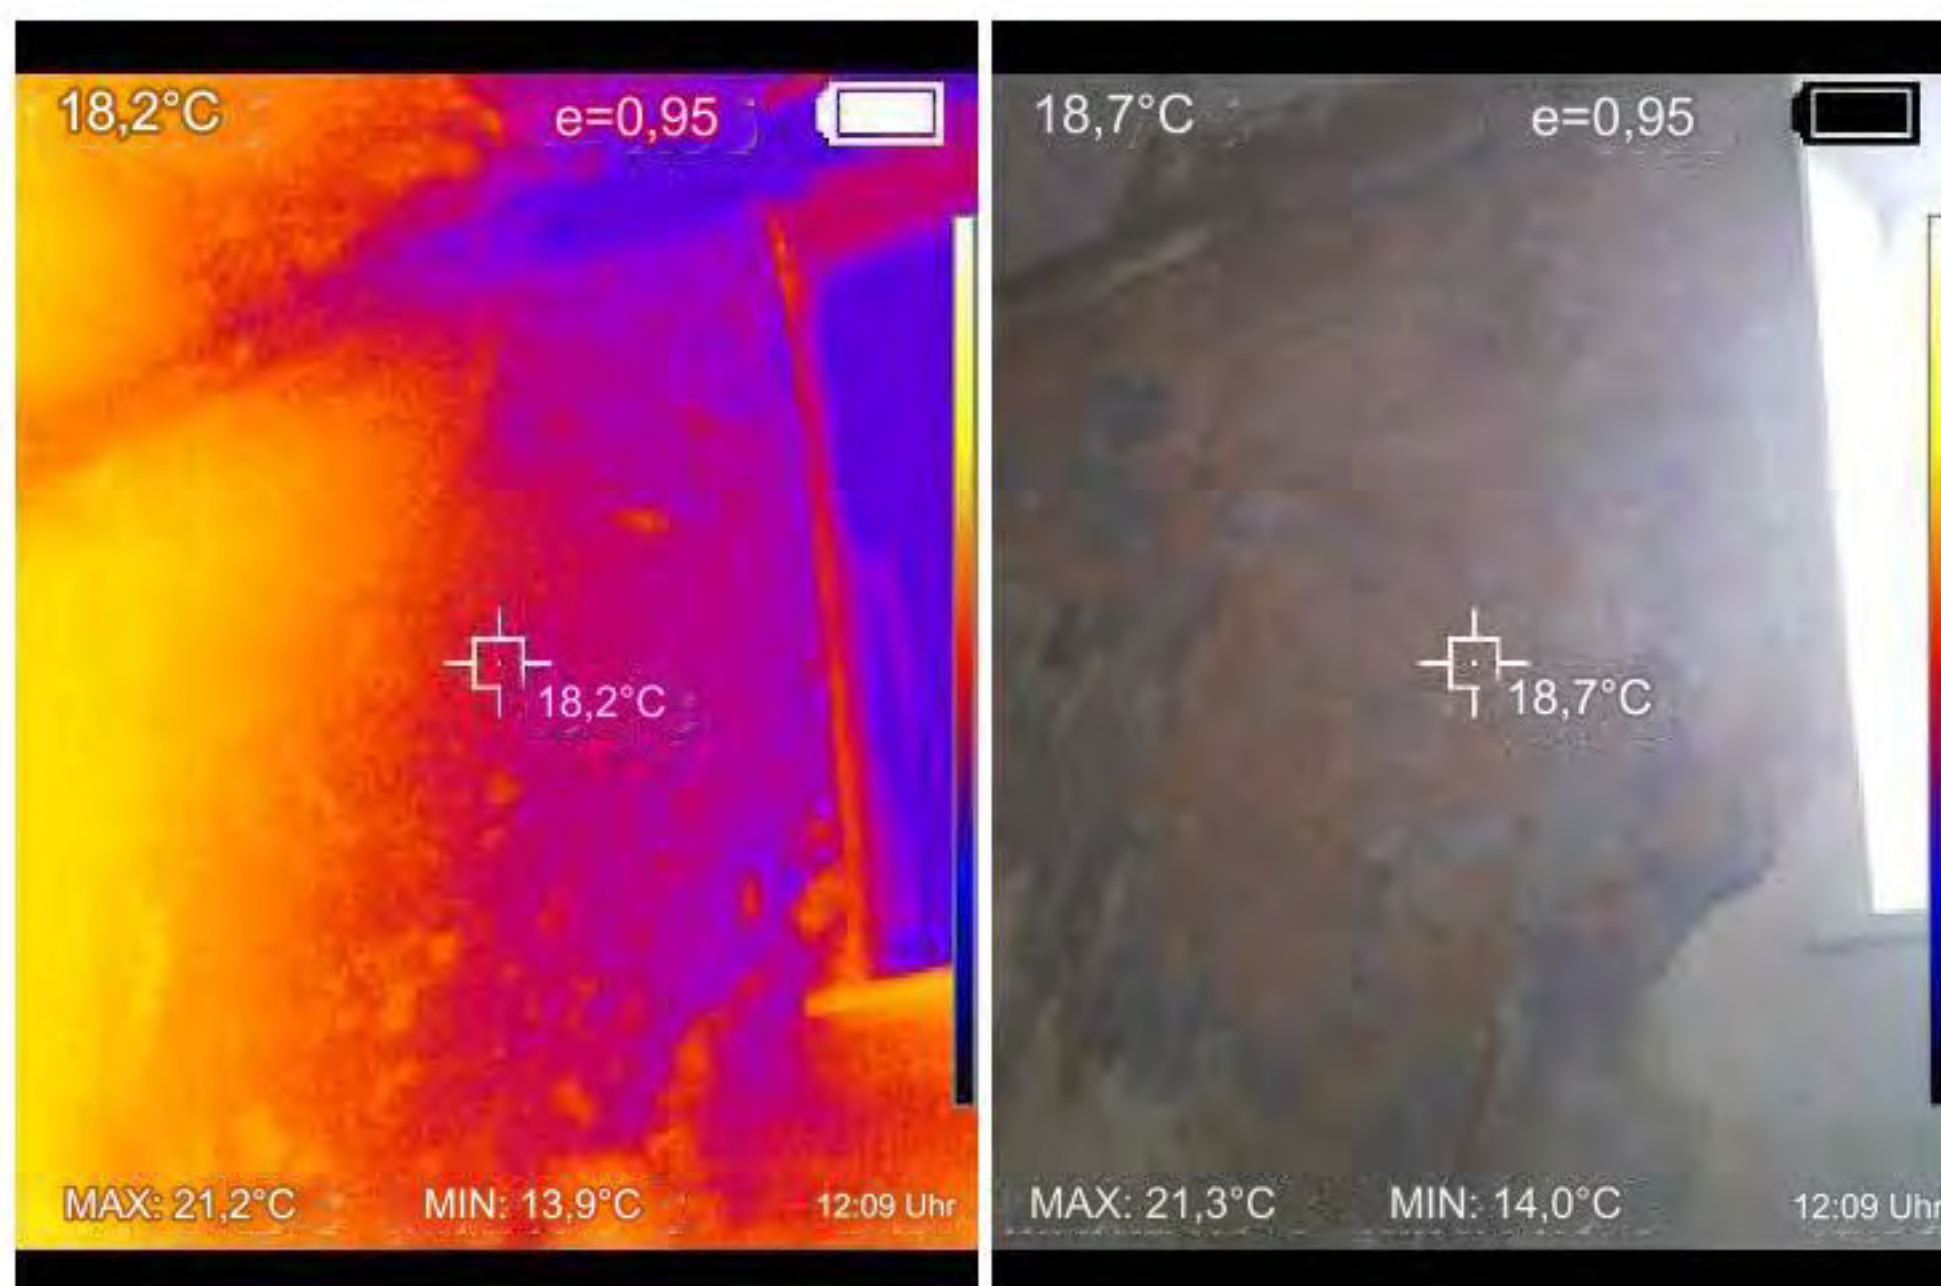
Spuren von Durchsickern durch die Elemente des Dachgeschosses
